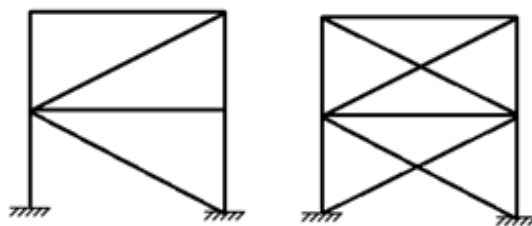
Sistema de pórticos com dois pavimentos contraventados
